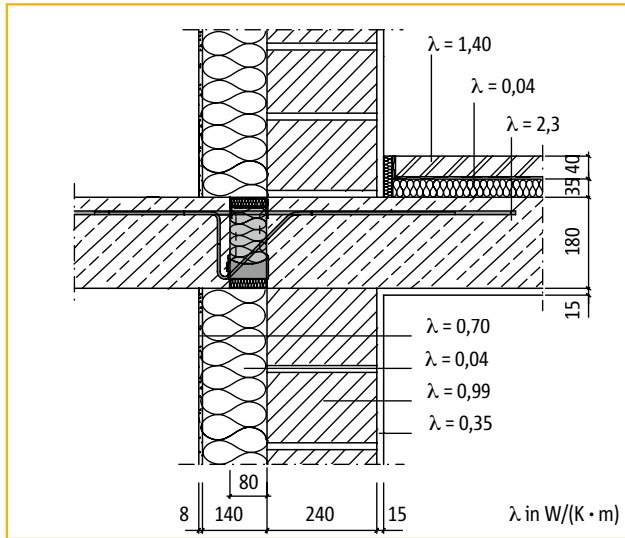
Anschluss Balkonplatte mit Schöck Isokorb® Typ K50-CV30-V6 bei Wärmedämm-Verbundsystem
